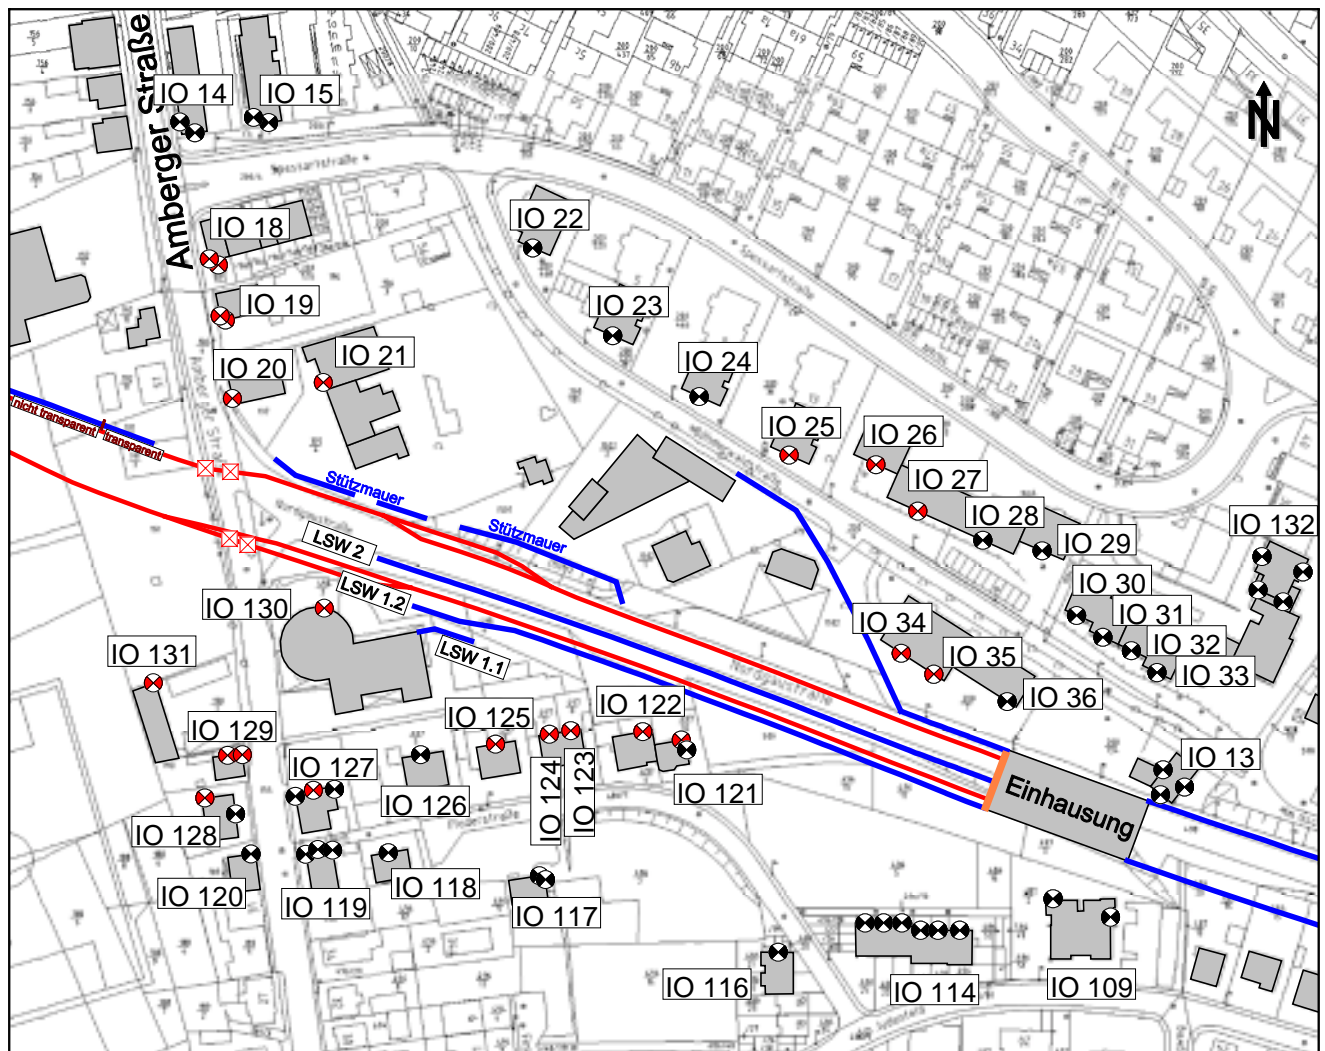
Lageplan "West" mit Kennzeichnung der Lärmschutzwände LSW 1.1, LSW 1.2 und LSW 2.
